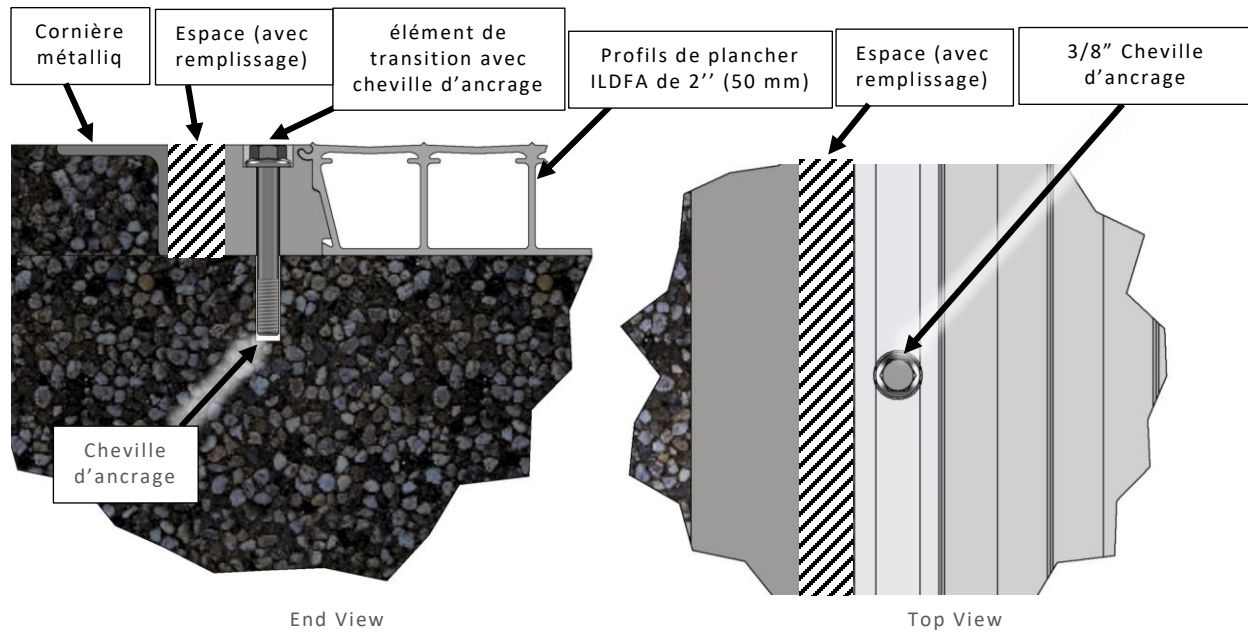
Transition entre la dalle du hangar et l'ILDFA avec dalle encastrée
